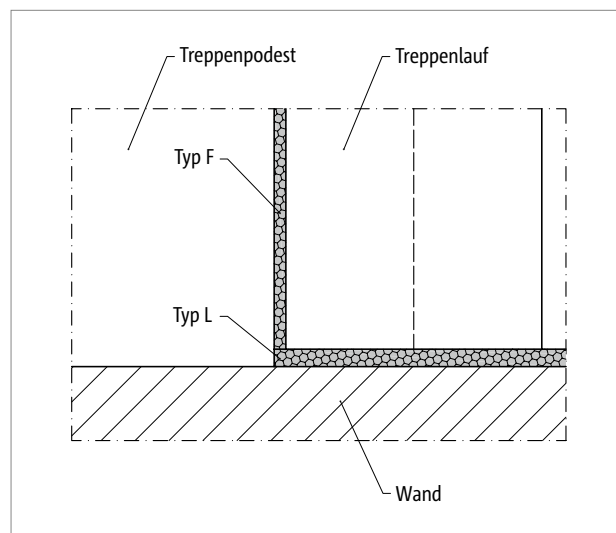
Tronsole® F: Elementanordnung, Detail B
